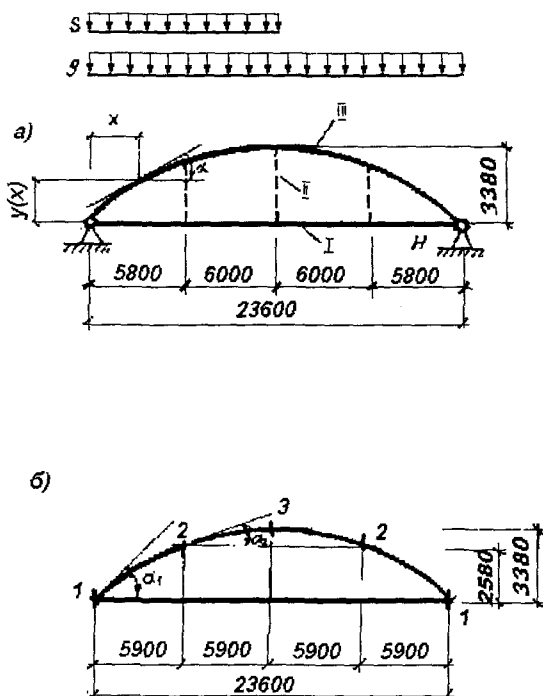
Расчетная схема (а) и расчетные сечения (б) двухшарнирной арки: I- затяжка; II- подвеска; III- арка
